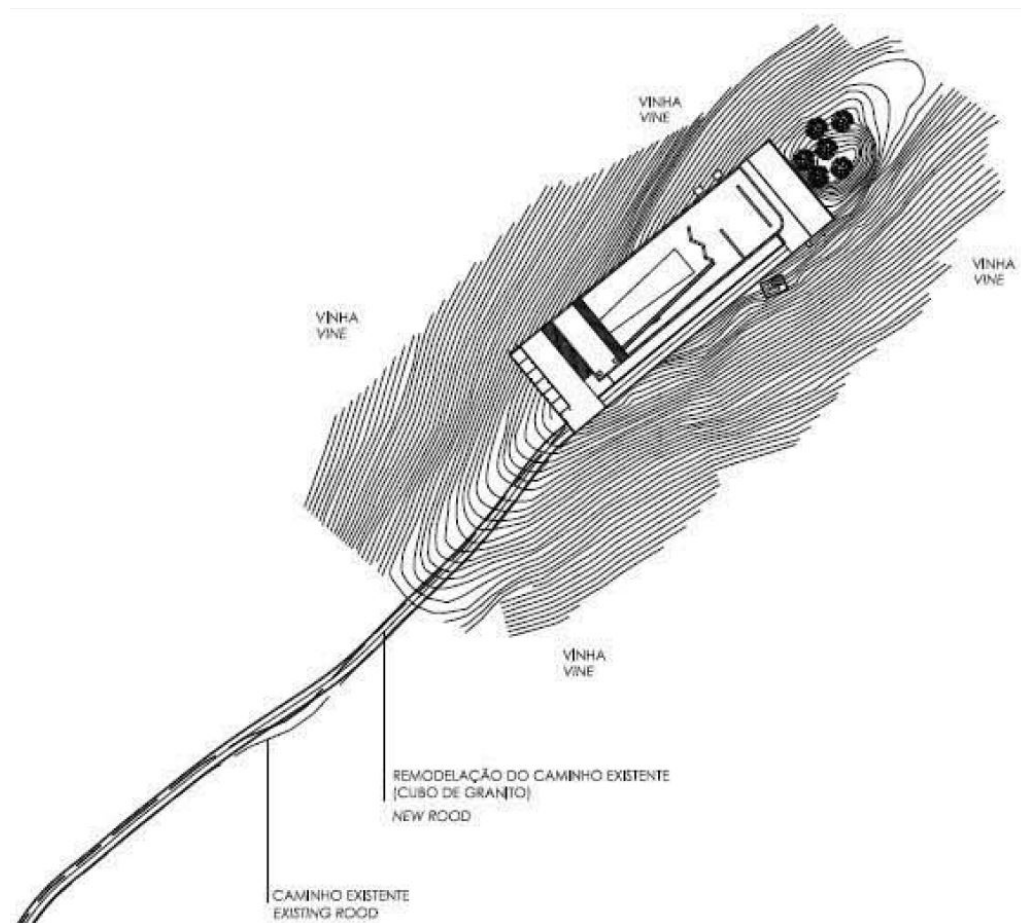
Adega Mayor - Planta de Implantação²⁵
